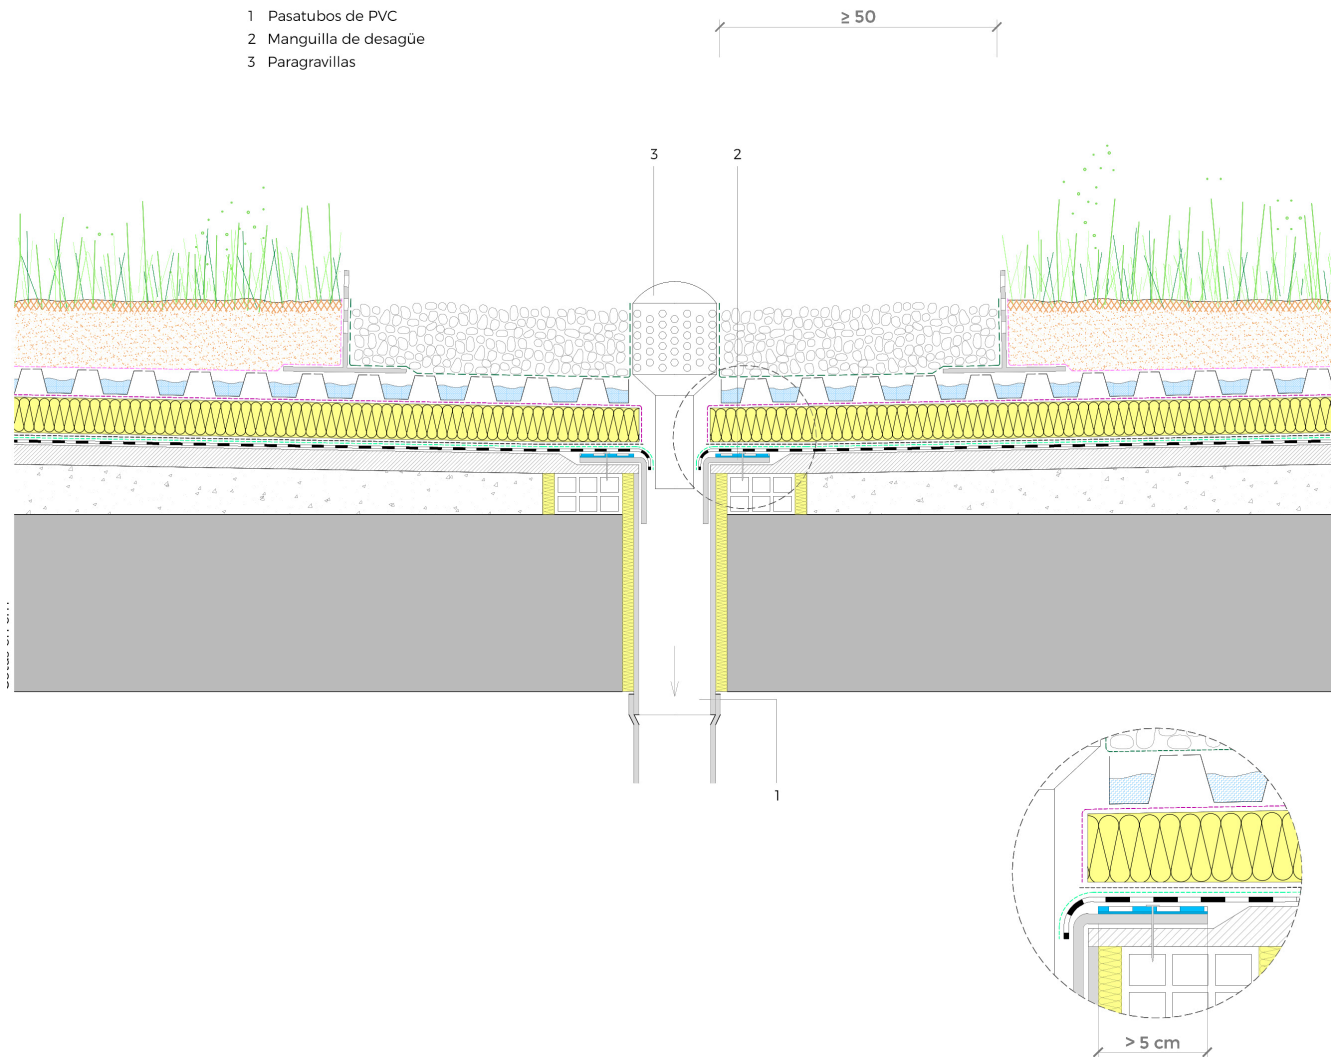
Encuentro de cubierta ajardinada extensiva o semiintensiva invertida con sumidero con paragravillas. Detalle del anclaje perimetral de la lámina impermeable de la cubierta alrededor del sumidero con perfil colaminado (azul).
